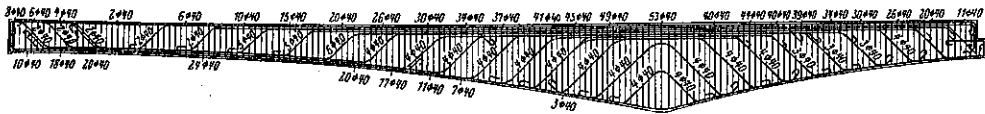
Pisa 近郊 Arno 河橋 (主桁の鉄筋配置)
